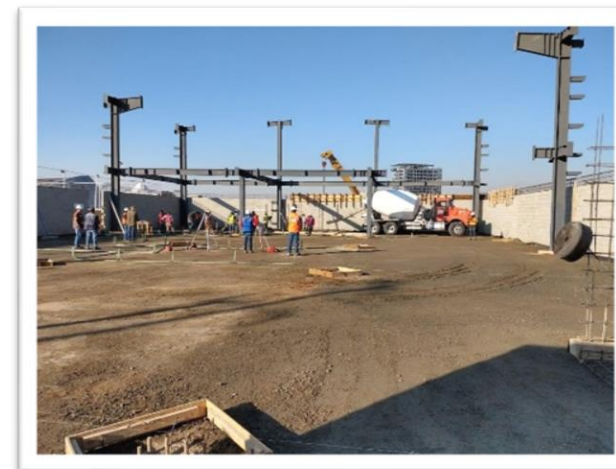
Montaje de estructura metálica y colado de traves de cerramientos. Autoría propia (2019)
